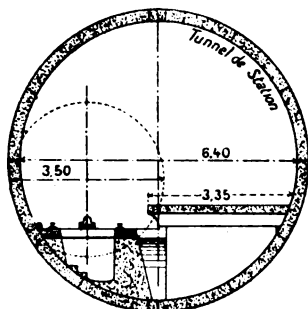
Coupe du Central London Ry (gare et tunnel).
